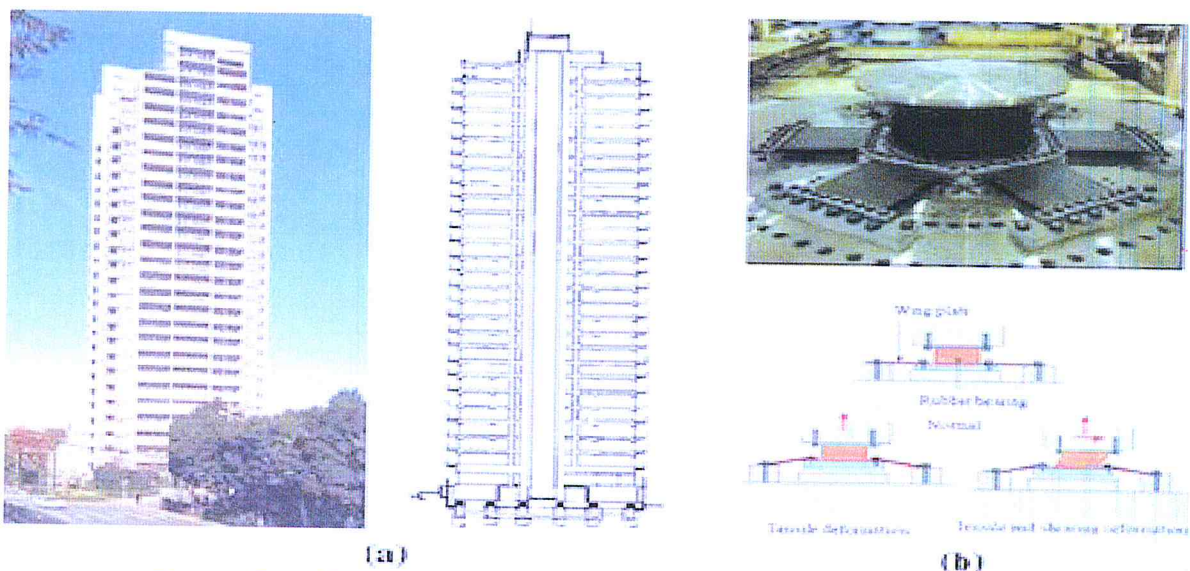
Vue en plan et en élévation du SENDI MT BUILDING.
